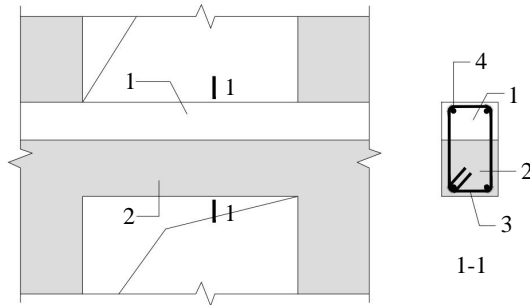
预制剪力墙叠合连梁构造示意
